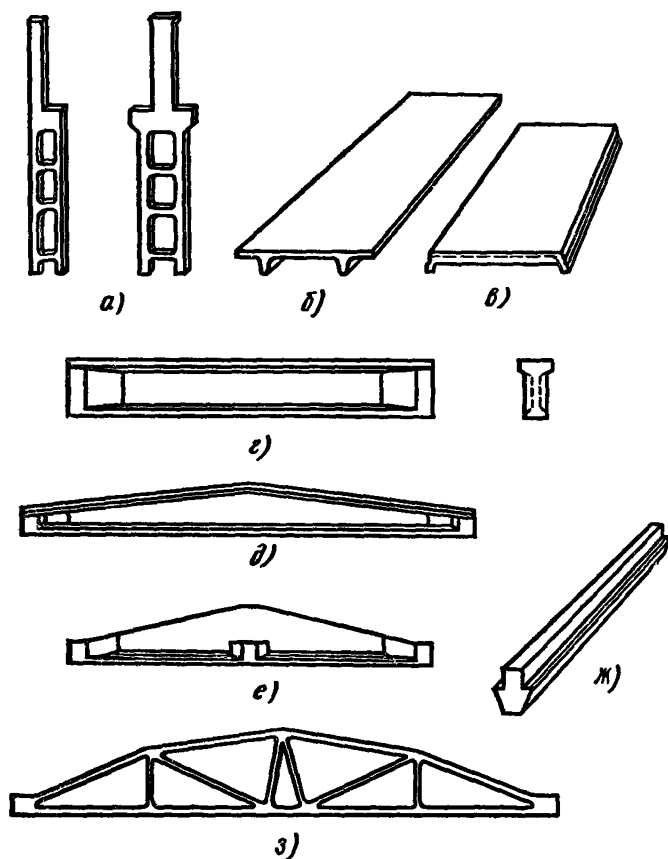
Схемы основных типов железобетонных изделий для производственного строительства:
